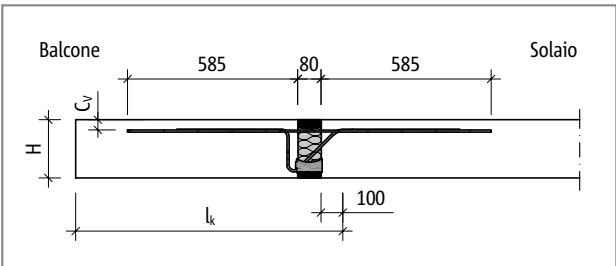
Schöck Isokorb® T tipo KL-M1 - M7: schema statico
